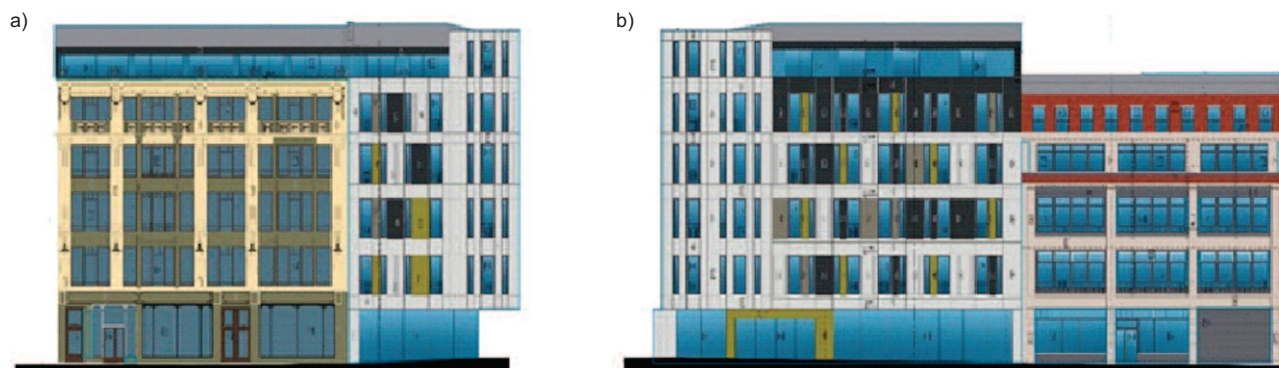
Wizualizacja nowej fasady rozbudowanego budynku z przeznaczeniem hotelowym
